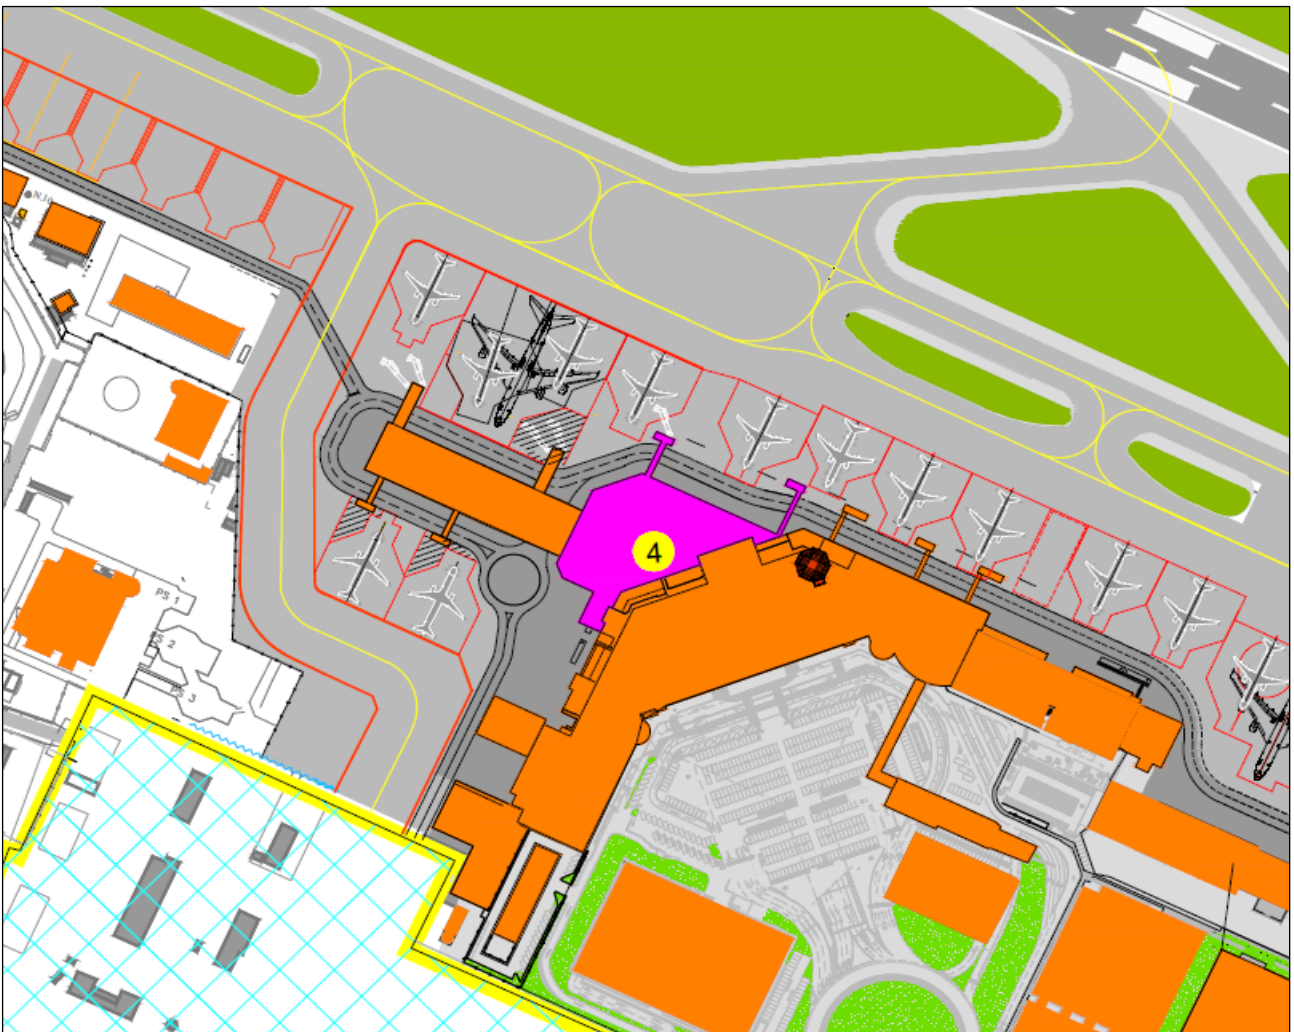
Estratto Master Plan – Ampliamento Terminal Fase 1
